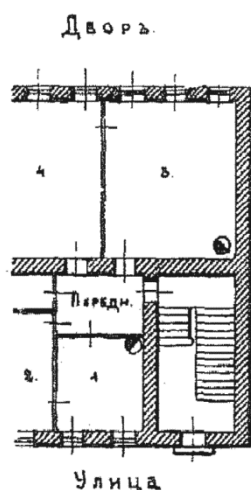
Расположение парадной лестницы на краю фасада [2]
